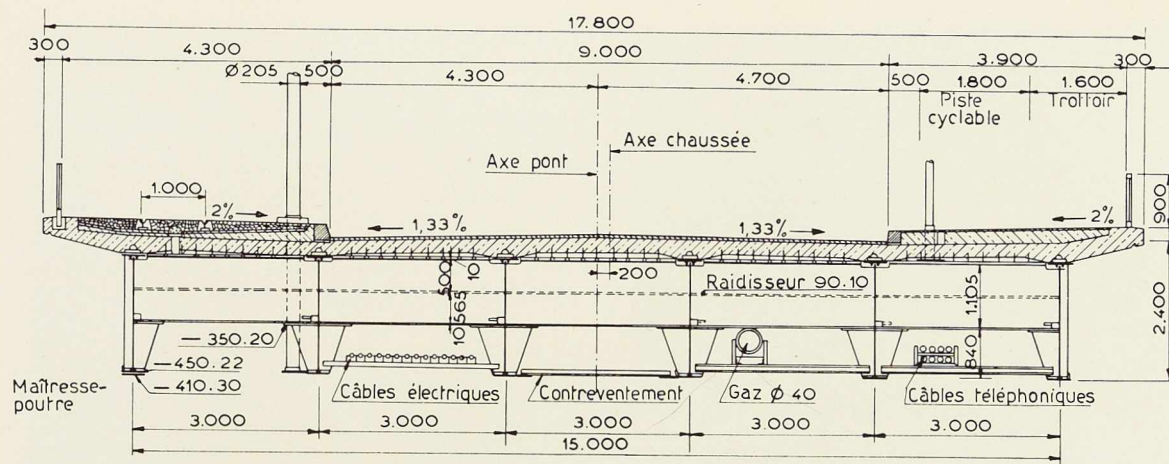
Coupe transversale du pont. Noter la disposition de la voie de tramways, nettement séparée de la chaussée carrossable.
